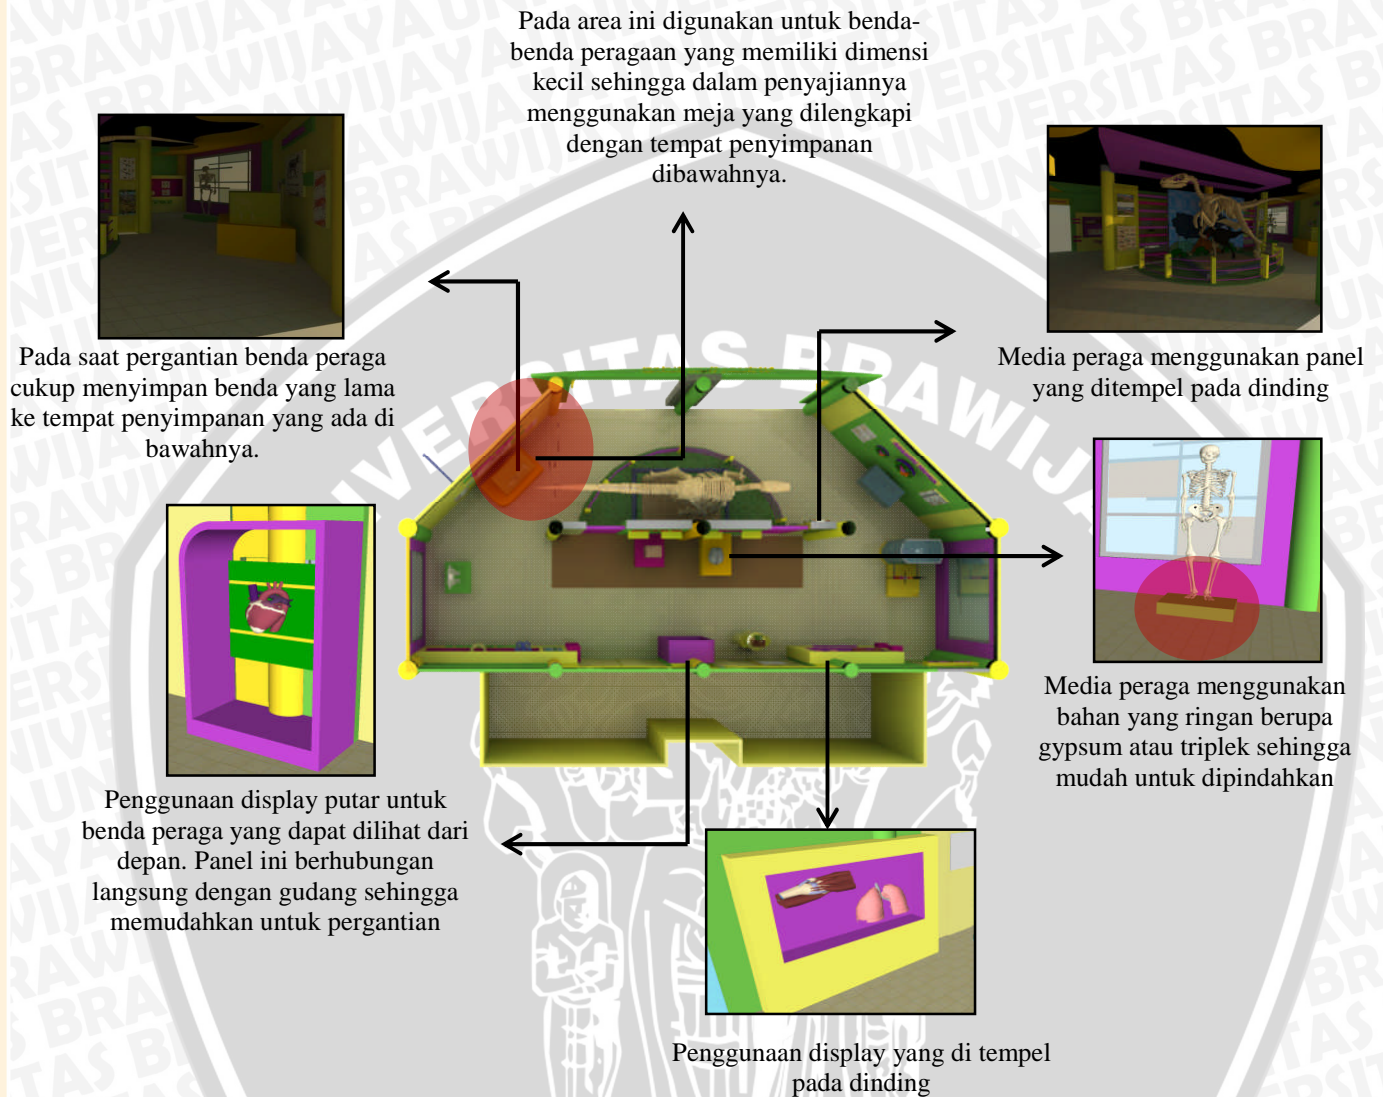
Contoh Alternatif I bentuk layout ruang peraga
